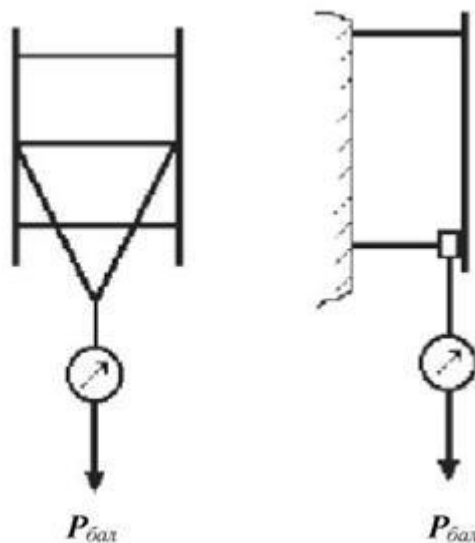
Схема приложения испытательной нагрузки для балки
